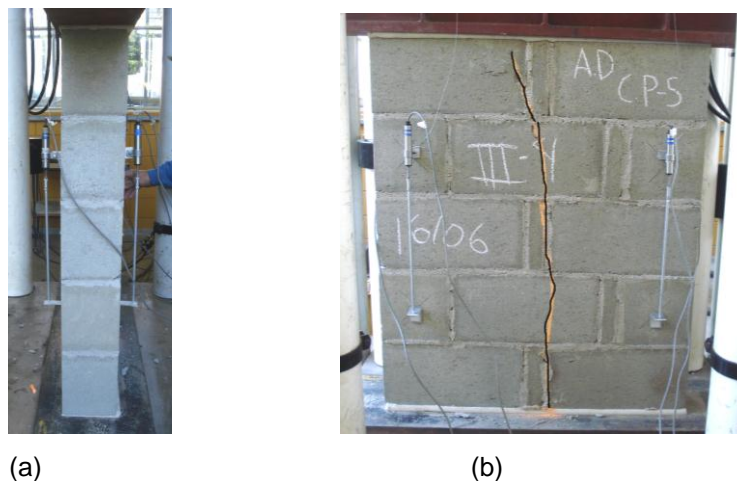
Vista lateral (a) e vista frontal (b) da mini-parede com argamassamento total com rapaduras (Série III).
